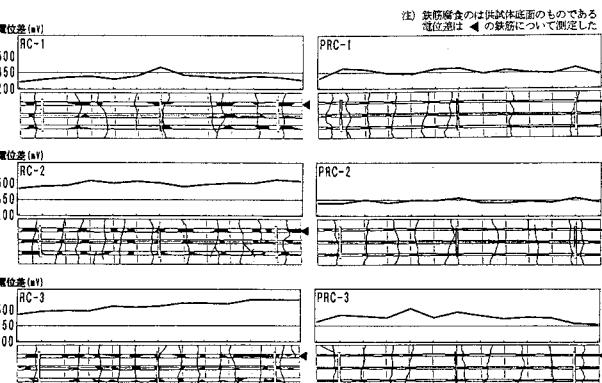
ひびわれ位置、鉄筋の発錆および電位差
